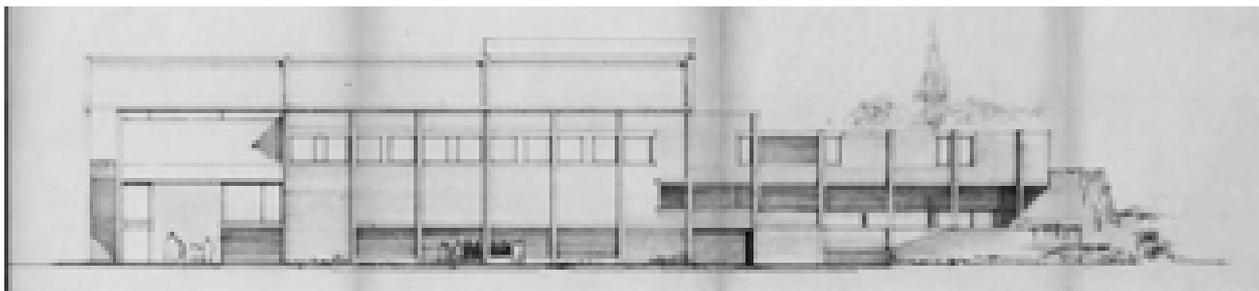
Prospetto, Ovest –08/12/1981 (AABS-1996.668)
